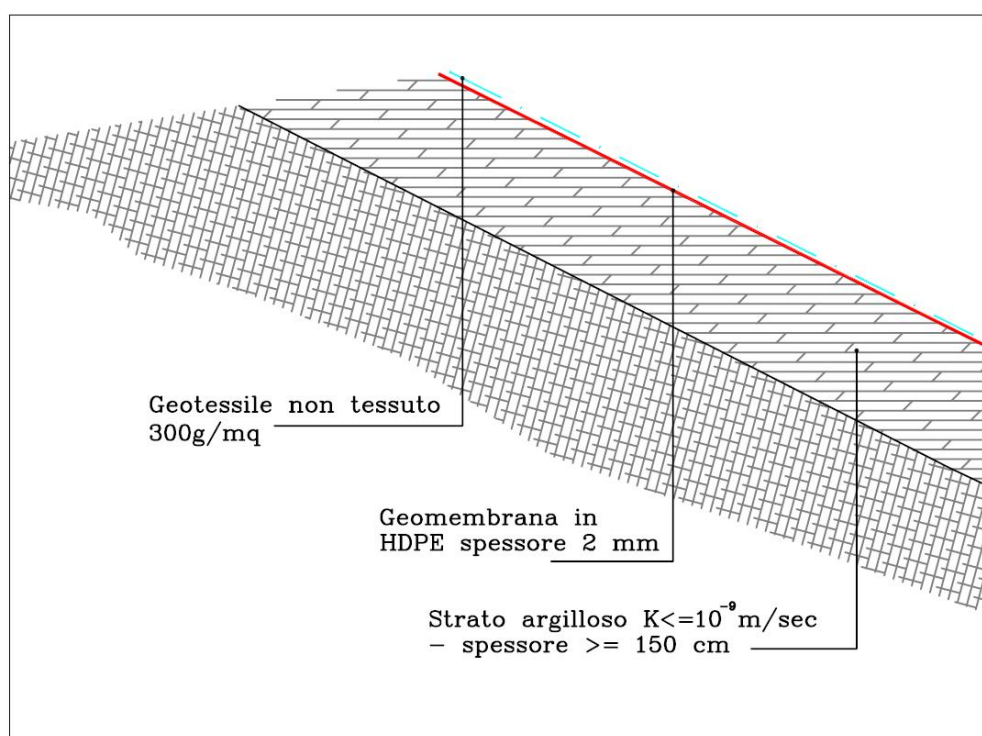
Particolare dell'impermeabilizzazione delle scarpate in progetto ⁽⁵⁾
